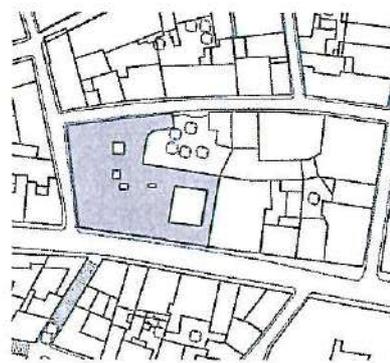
Planta de Implantação do Palácio do Monteiro-Mor | Escala 1:2000
